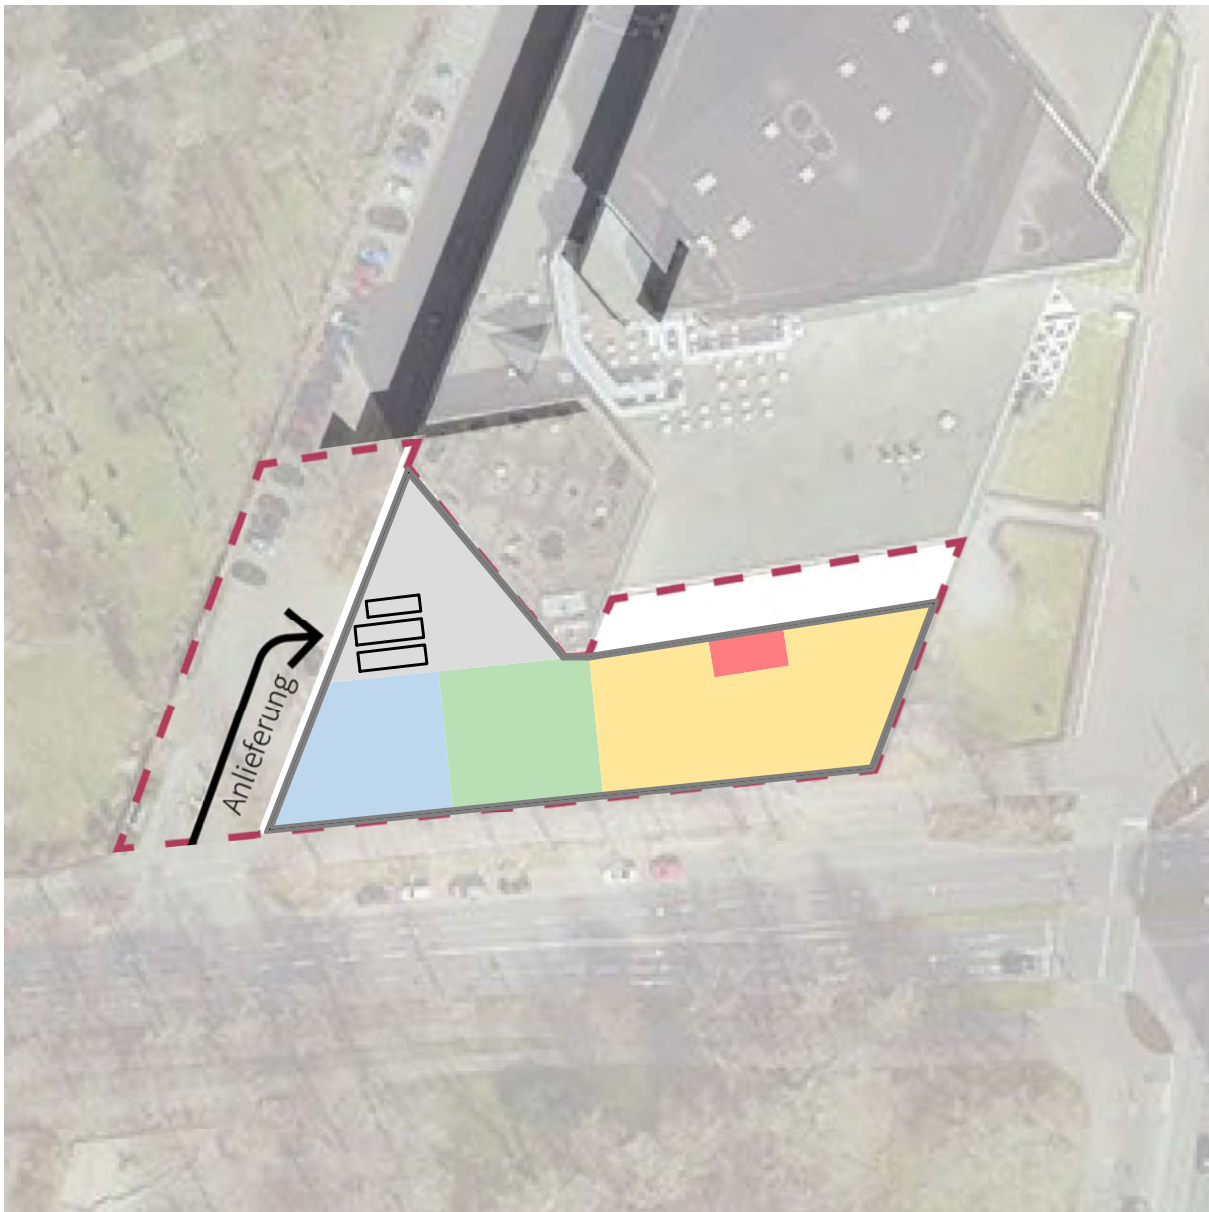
Grundriss EG Stadthalle V1
